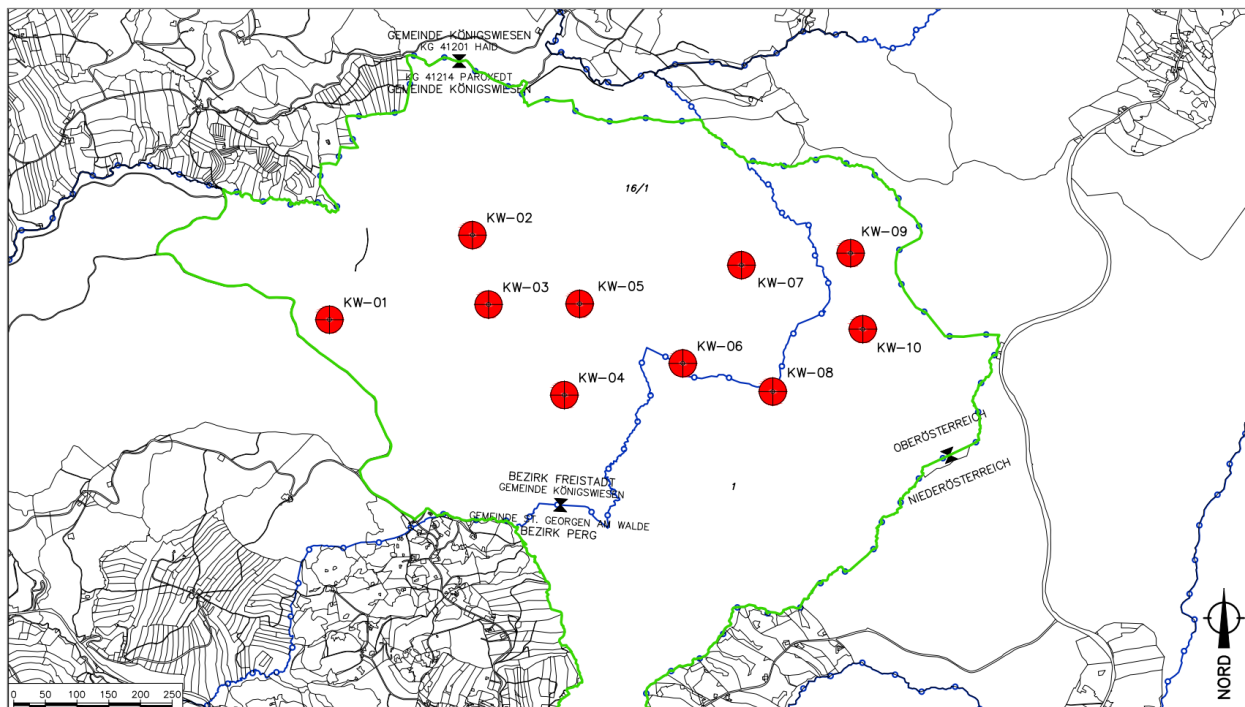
Lageplan mit Anlagenpositionen und berührten Grundstücken [Kartenquelle: BEV]
